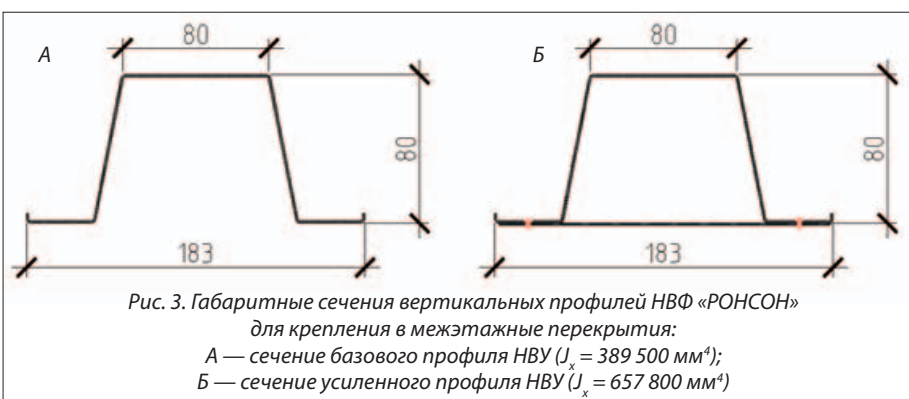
Габаритные сечения вертикальных профилей НВФ «РОНСОН» для крепления в межэтажные перекрытия:
